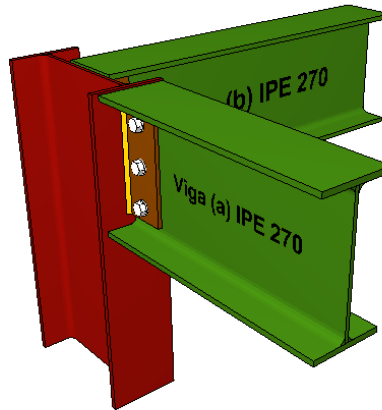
Unión articulada pilar de esquina de la estructura de oficinas y vestuarios
